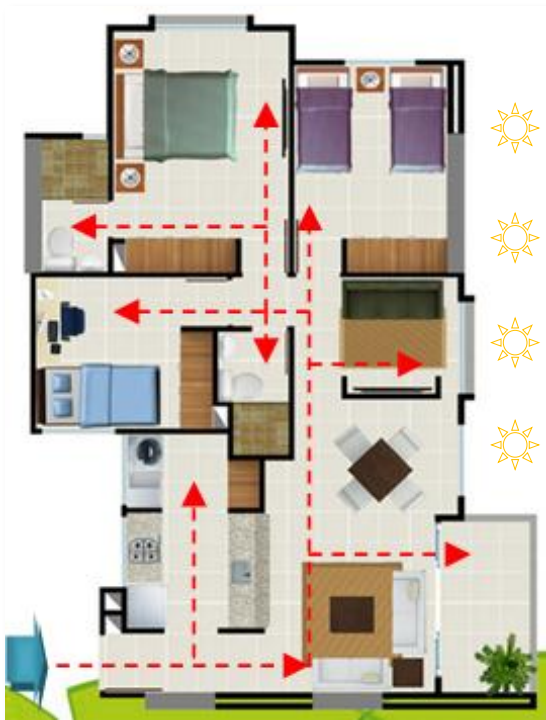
Plano de conjunto: Asoleamiento y ventilación.
